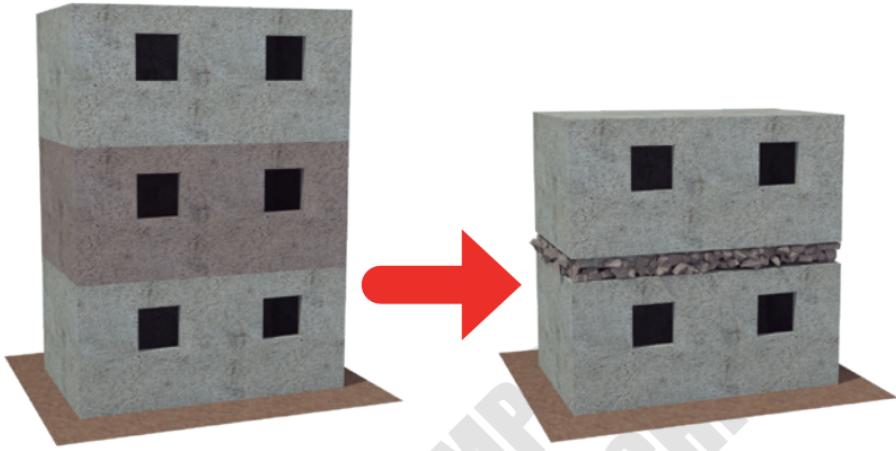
Sobre la torsión (falla en las columnas y posible colapso de piso).
